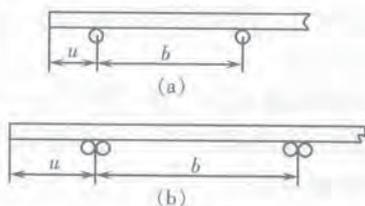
焊接网纵向钢筋和横向钢筋
